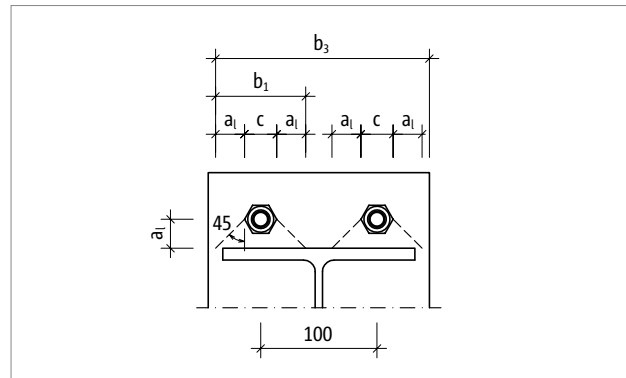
Plaque frontale saillante T type S : calcul des entrées géométriques ; vue globale
